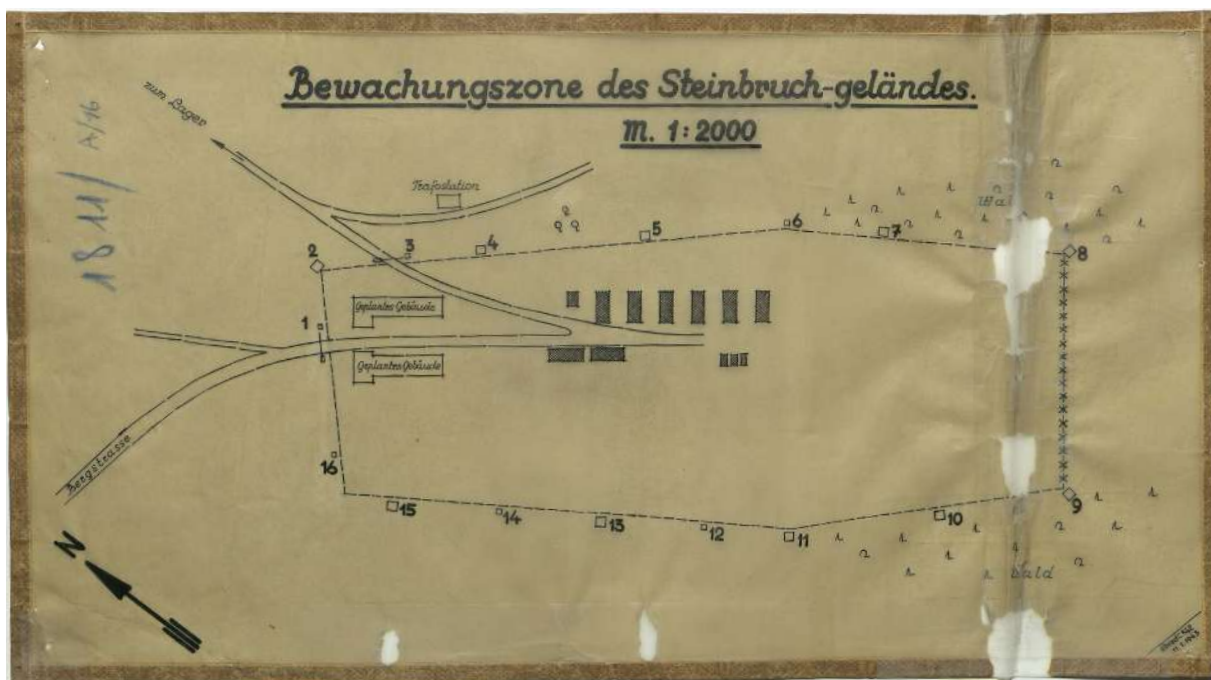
Plan de la carrière en janvier 1943. 6 halles sont construites (NATZ19_PL_DE_118).
